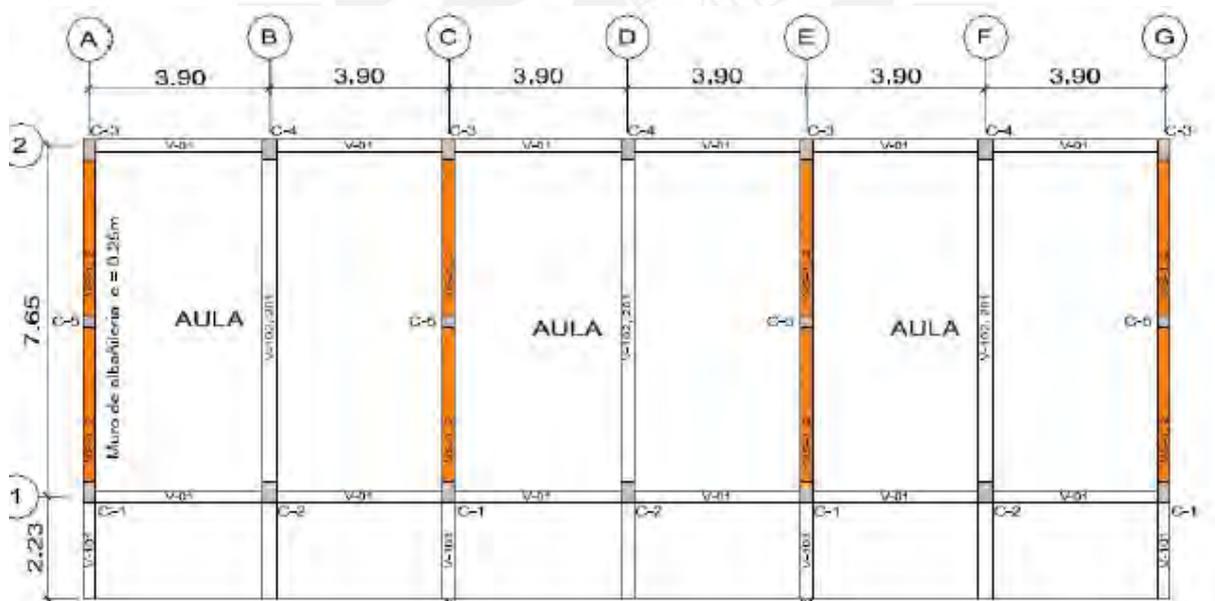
Vista en planta de un módulo típico 780 Pre. (Fuente: Informe DAI, 2007)
